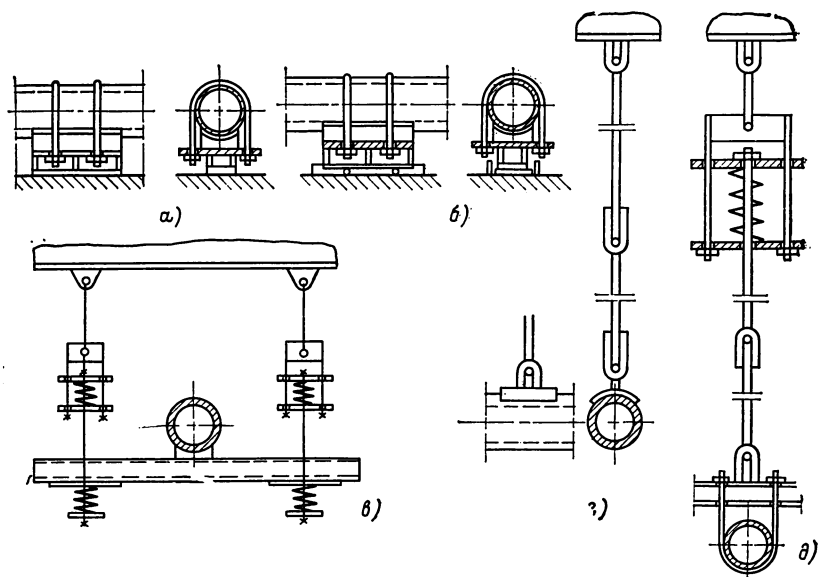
Конструкционные схемы опор и подвесок для трубопроводов:
